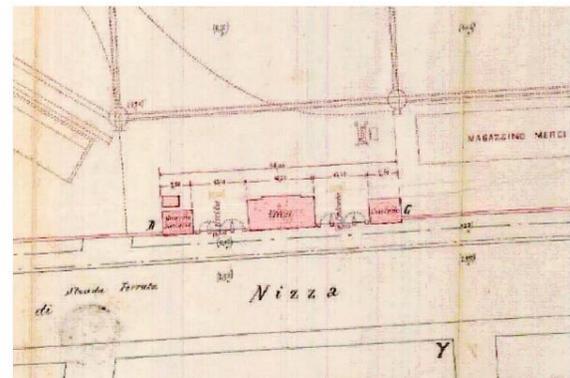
Planivolumetrico – dettaglio area sud Tavola B.16.1
